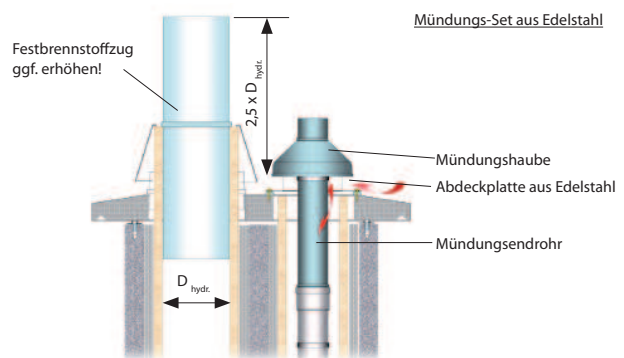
, Mündungsausbildung bei Schornsteingruppen mit Festbrennstoffzug, raumluftunabhängiger Betrieb
